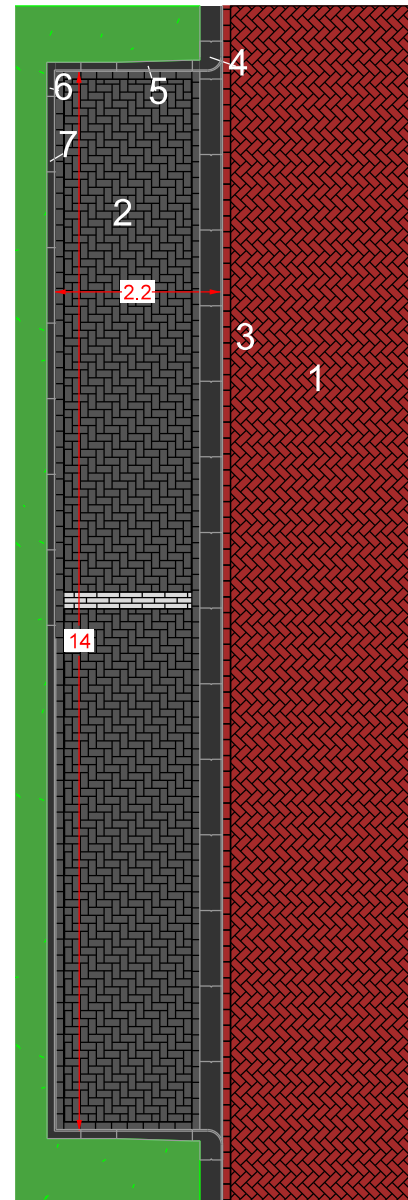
Laan met langsparkeren gekoppeld aan inrit
